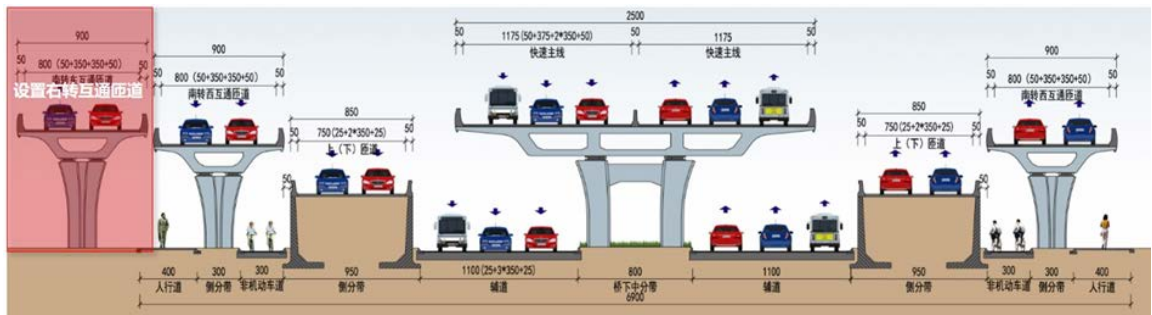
五星枢纽增设南转东匝道（范公路段）标准横断面图
